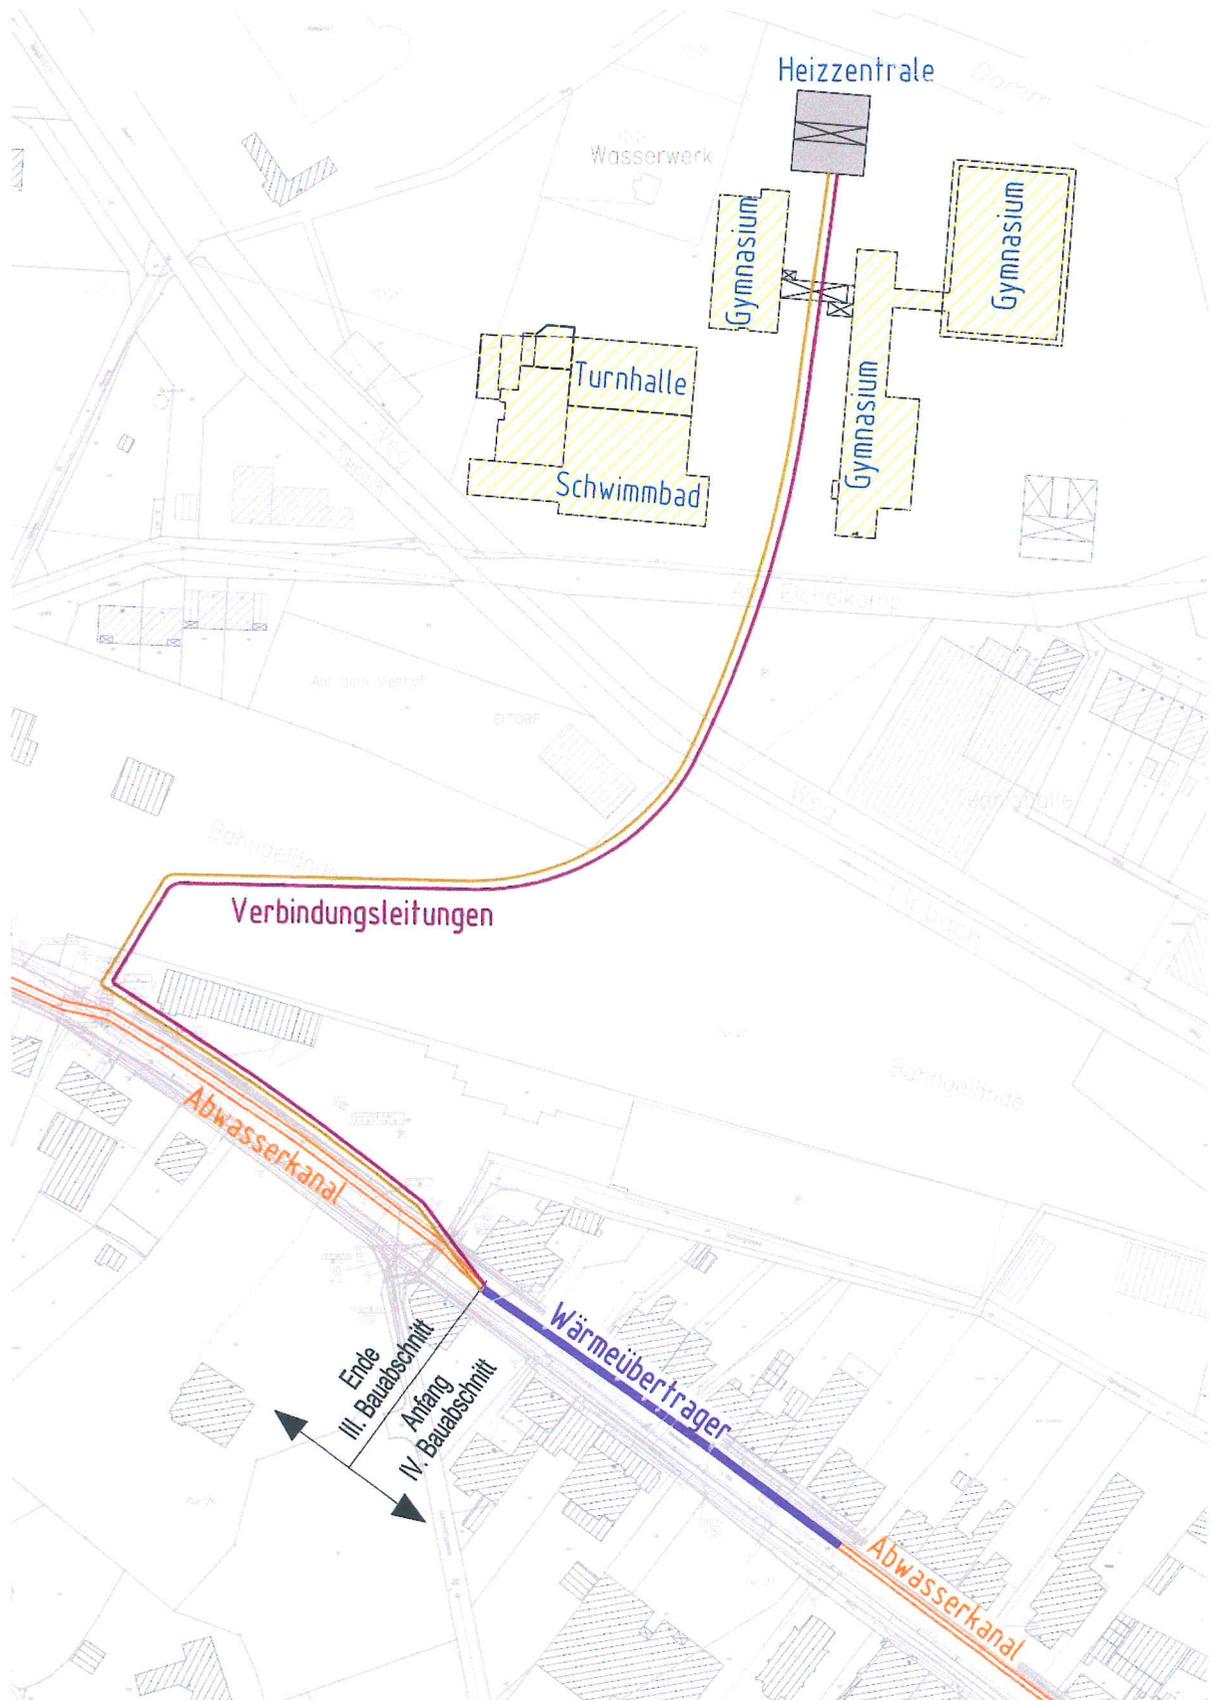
Lageplan Abwasserwärmeübertrager im 4. Bauabschnitt und Trasse Verbindungsleitung
